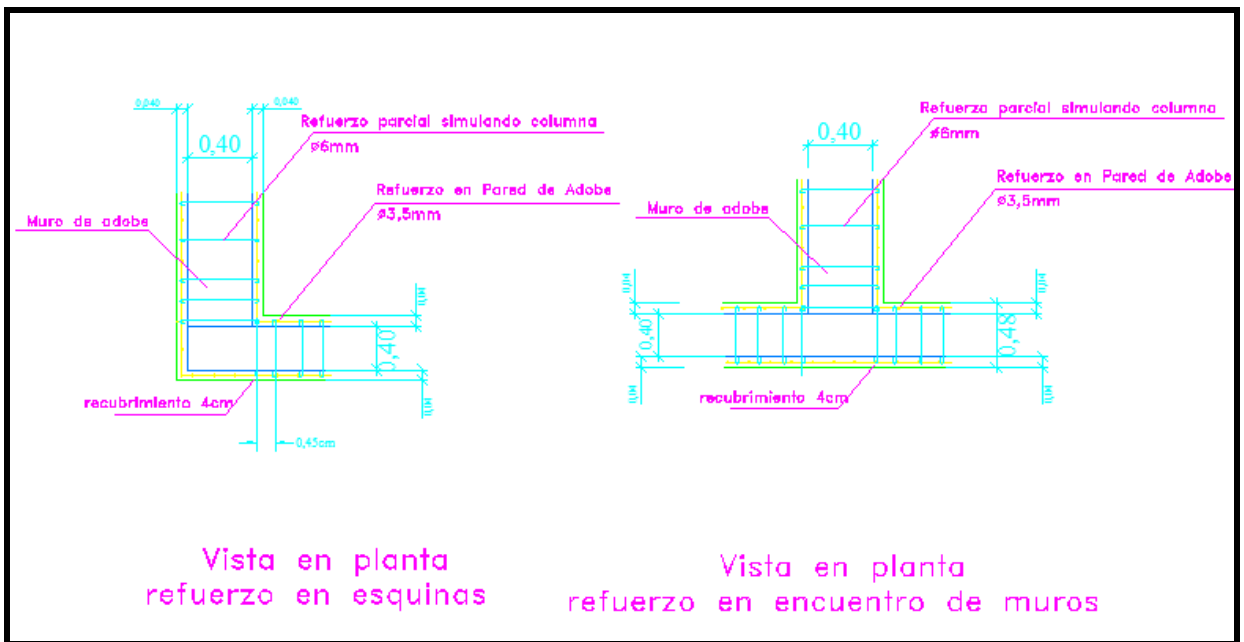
Refuerzo de encuentros en L y en T vista en planta
